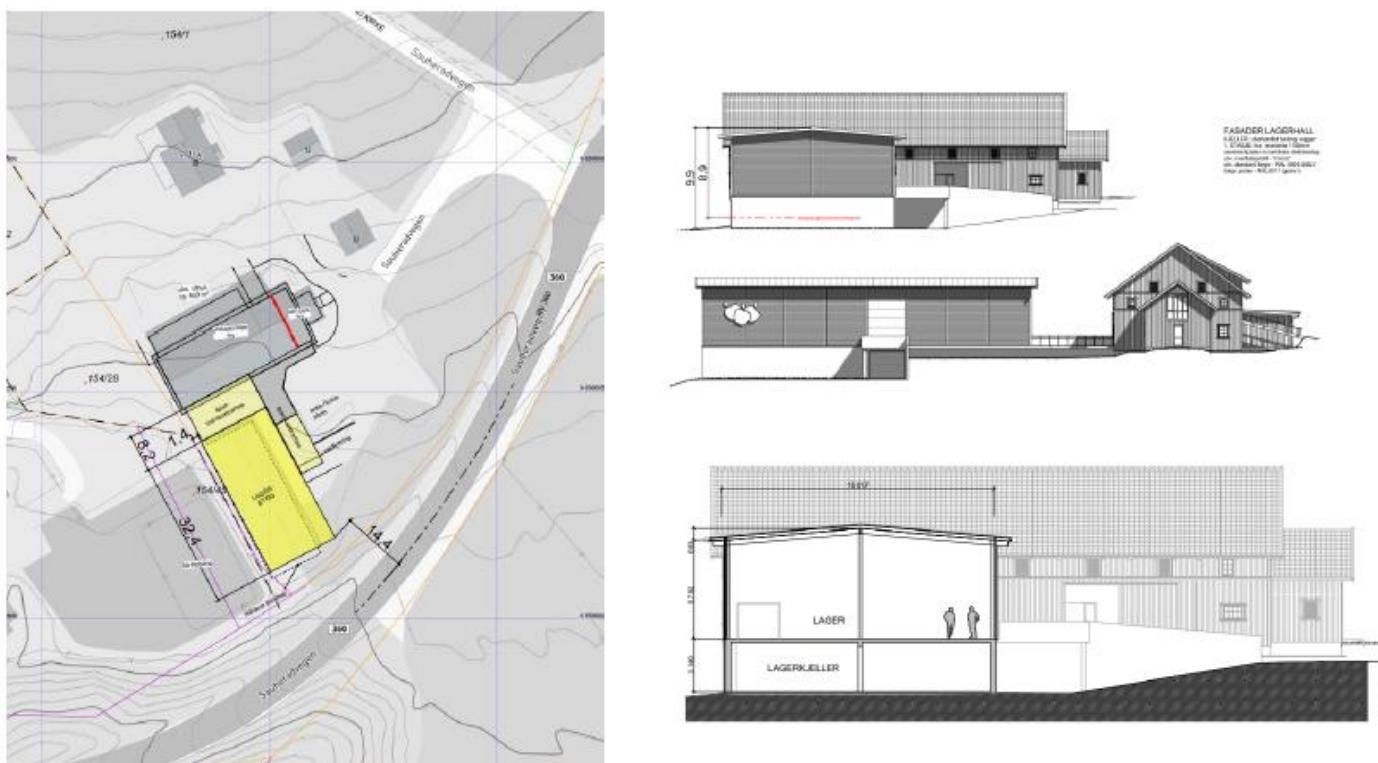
Planlagt utbygging av lagerhall. Situasjonsplan, fasader og snitt av eksisterande og nytt lagerbygg..
